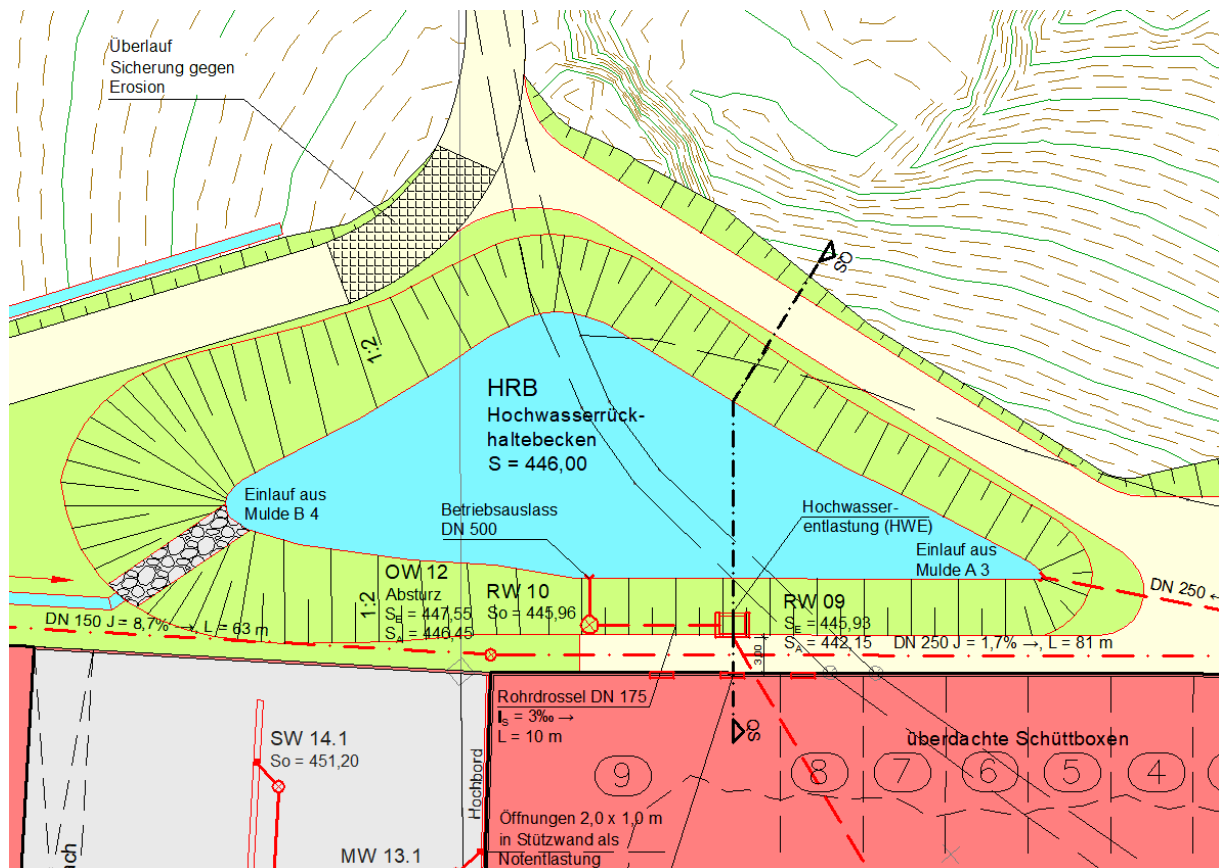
Lage Betriebsauslass und Hochwasserentlastung
